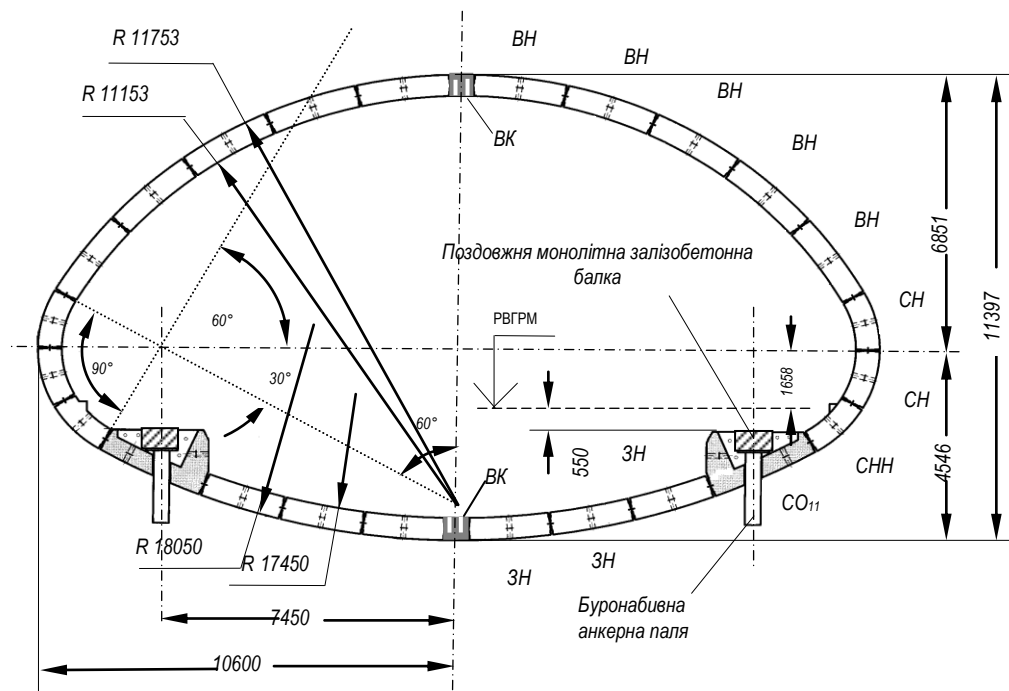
Поперечний переріз універсальної споруди станційного комплексу
